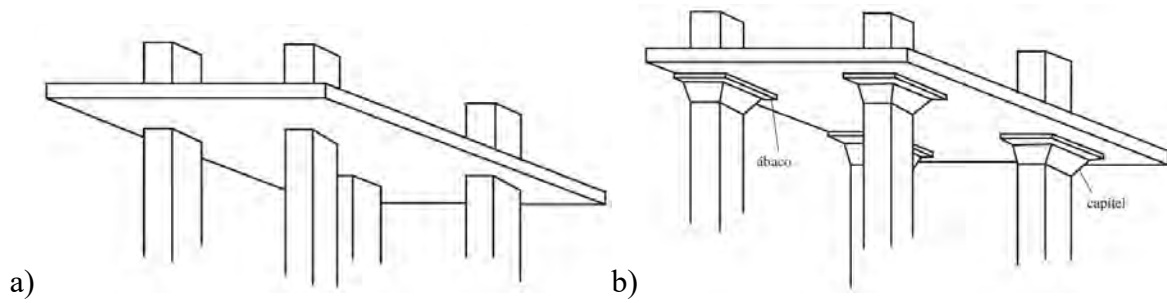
a) Placa plana, b) losa plana (figuras tomadas del libro “Diseño de concreto” R. McCormac)
